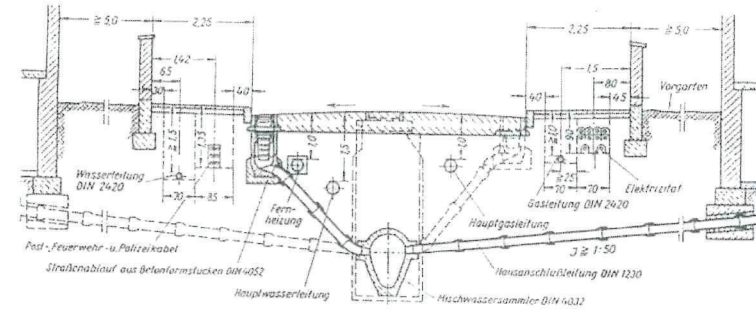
Straßenquerschnitt beim Mischverfahren
